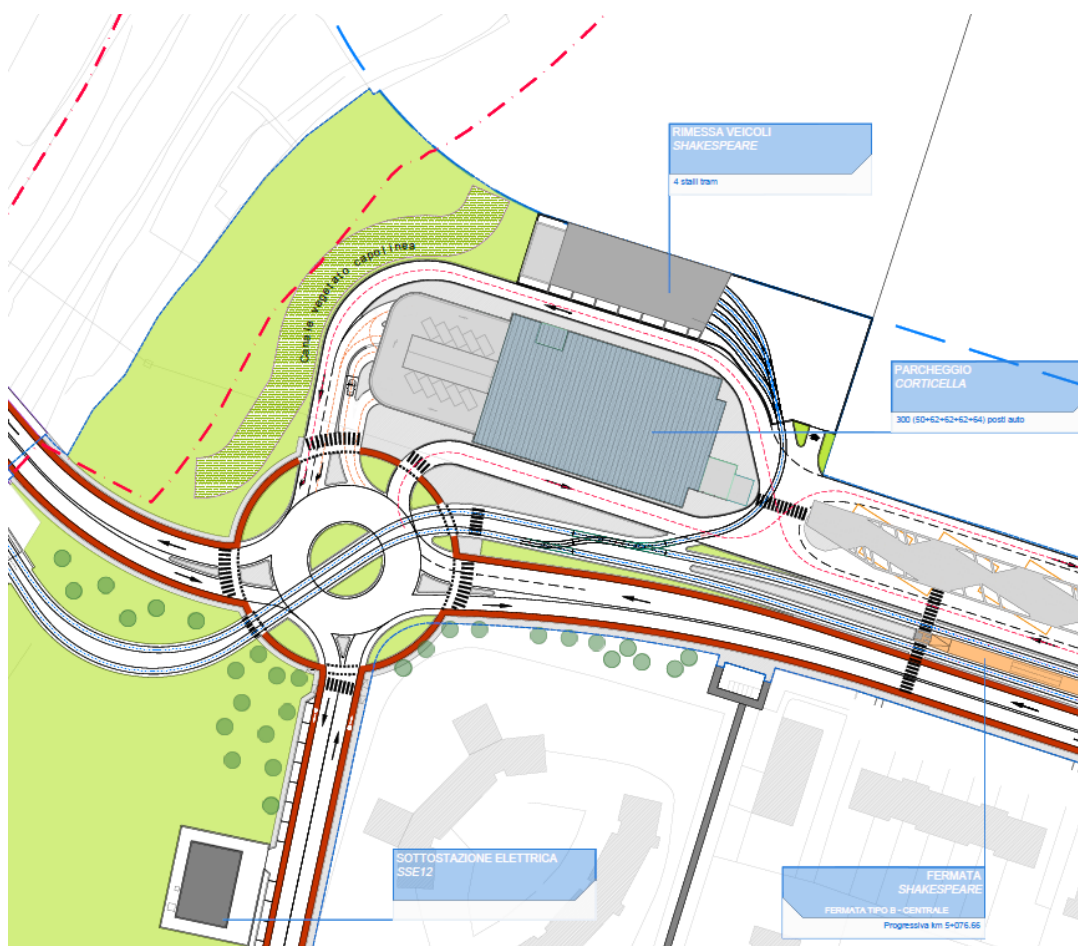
Estratto della Planimetria inquadramento: Rimessa Tram via Shakespeare
